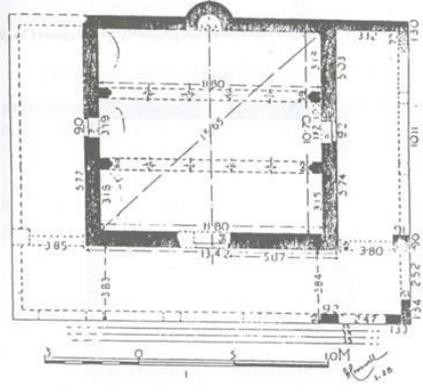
مسقط أفقي لمصريح الرملة بفلسطين . (عن ، كريزول).
